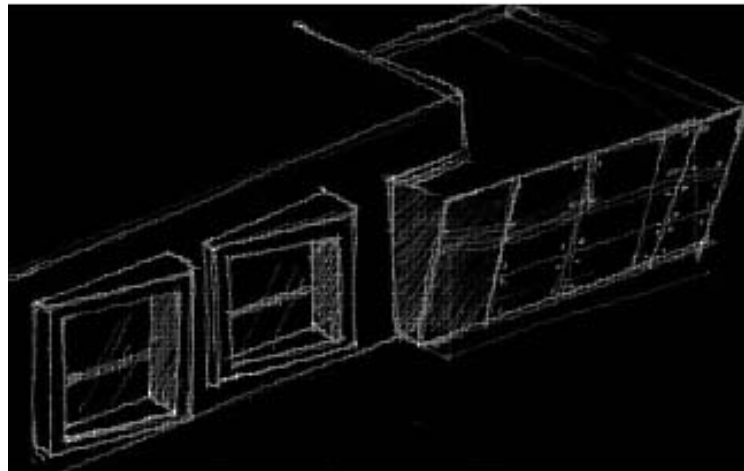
Imágenes Conceptuales “Fachada Biblioteca y cubierta de la cafetería (lonaría)
